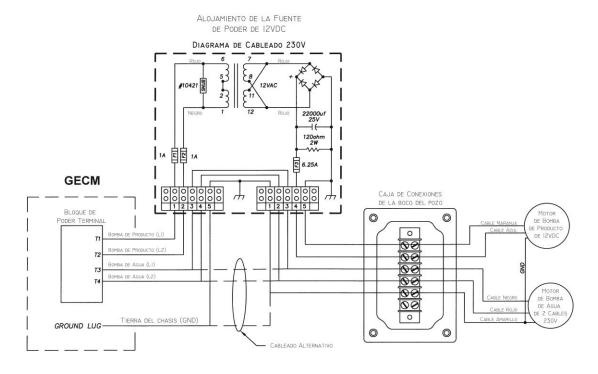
Cableado de los motores de la bomba de agua de 2 cables 230VAC y bomba de producto 12VDC
